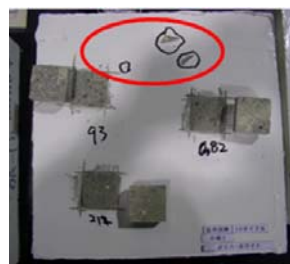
温冷繰返し試験後の膨れ(試験体No.2-3)
